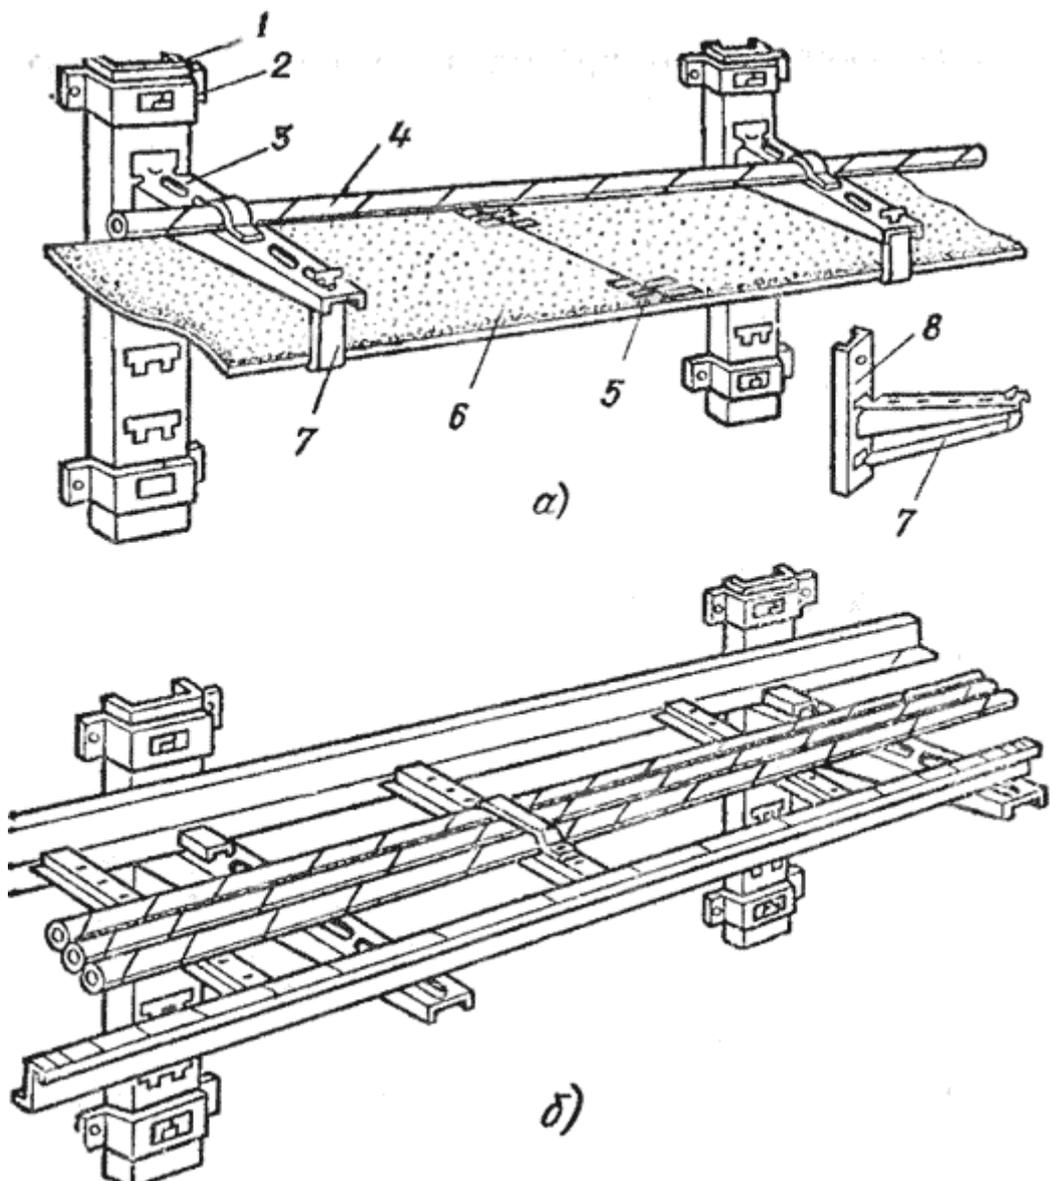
Прокладка кабелей на опорных конструкциях: а — на полках; б — на лотках; 1
